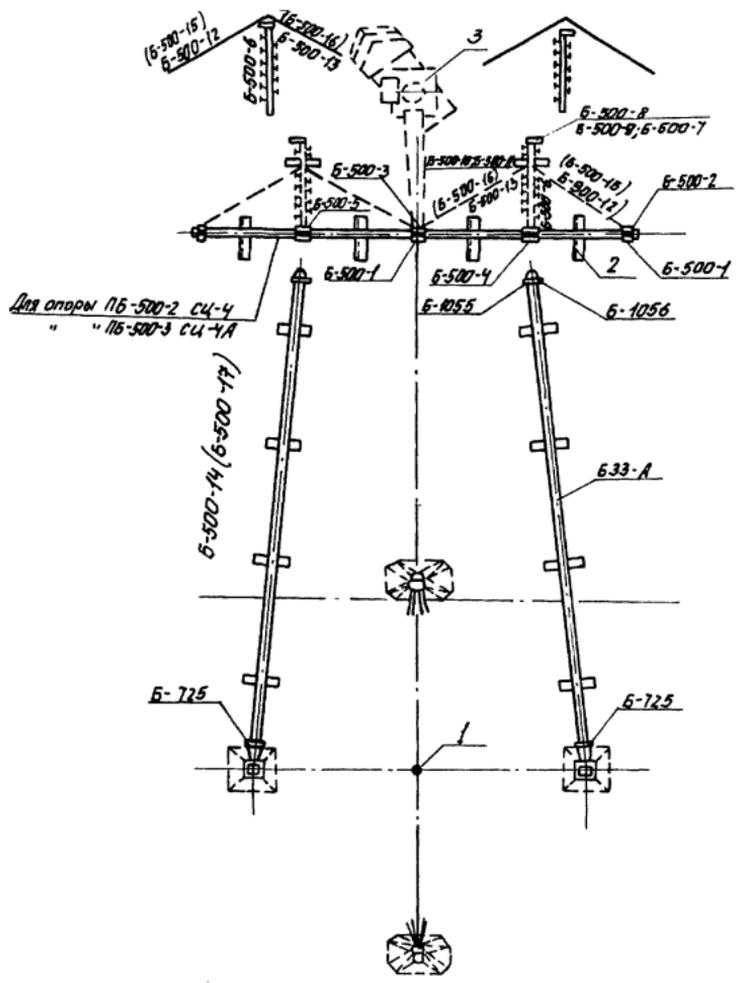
Схема сборки опоры ПБ-500-2 (ПБ-500-3)
